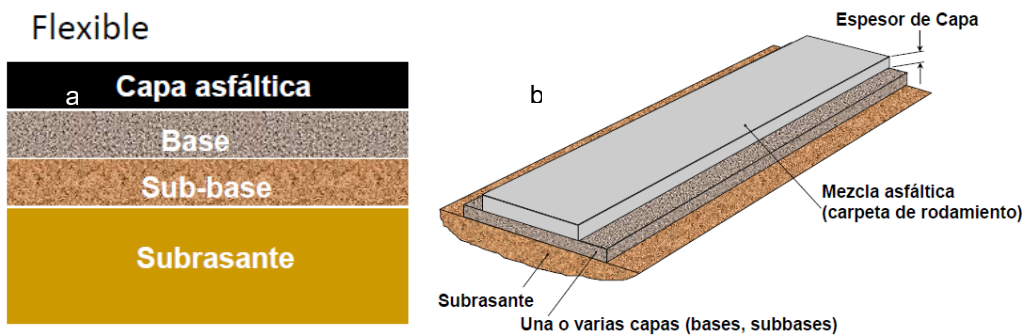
Estructura de pavimento flexible. a) Esquema corte. b) Esquema longitudinal. (Campana, 2014)
